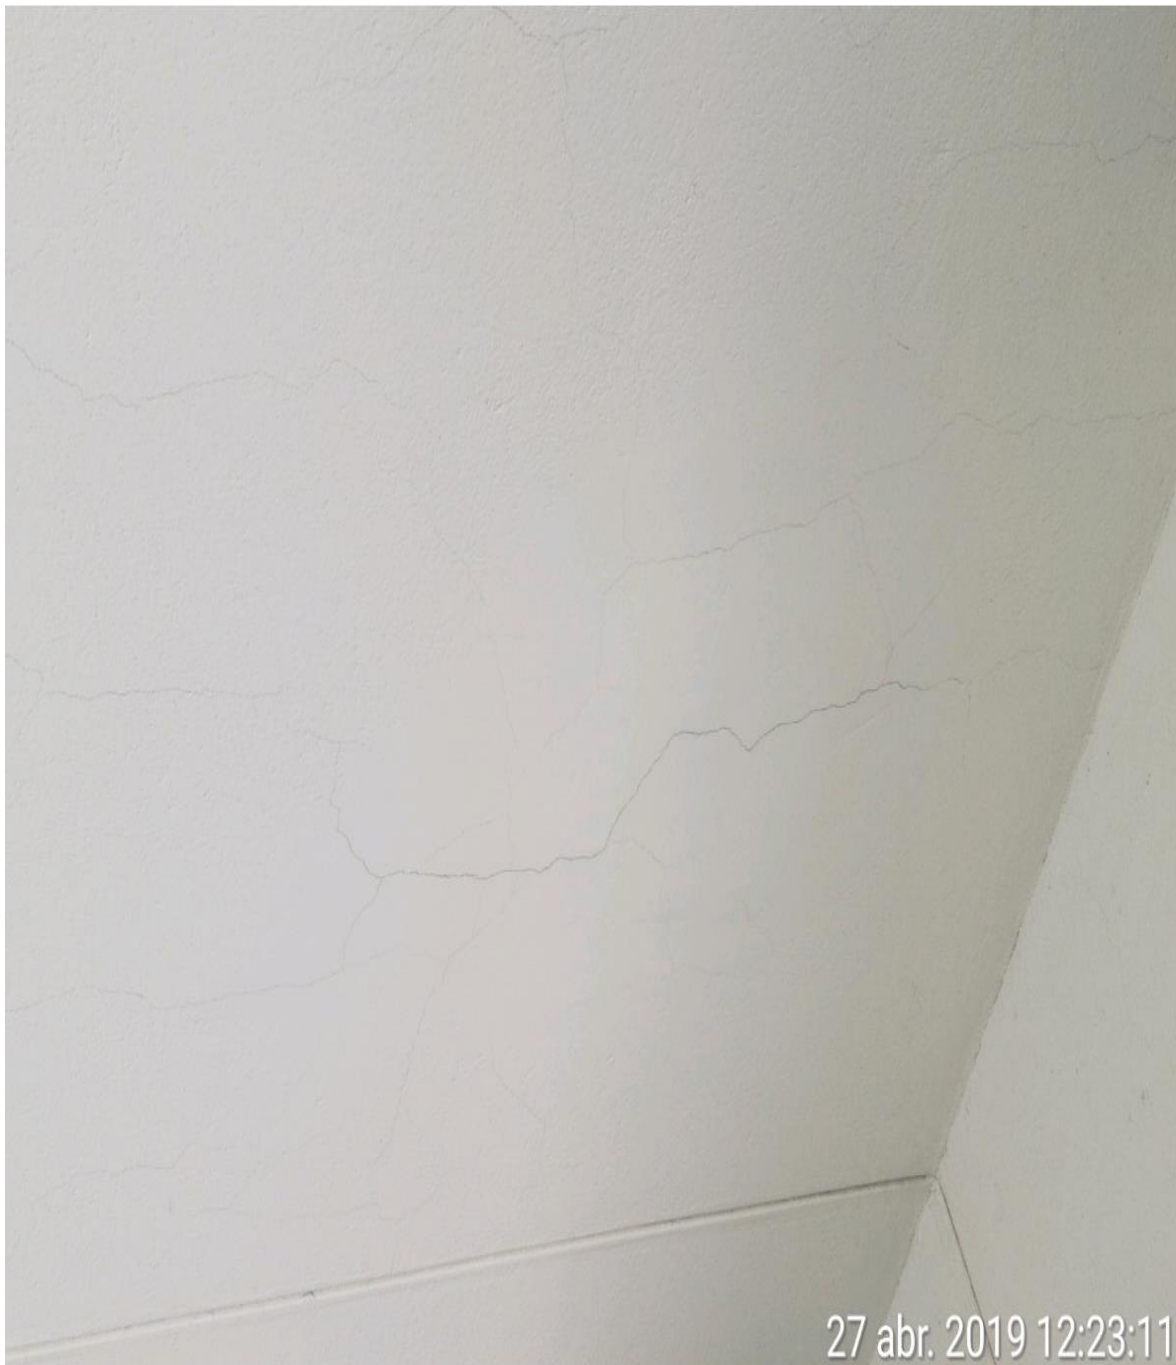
Fisura en Columna de Dormitorio 03, Departamento 502
